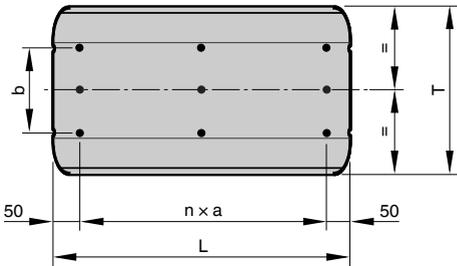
Anordnung der Bohrschrauben zur Befestigung der Kulissen
